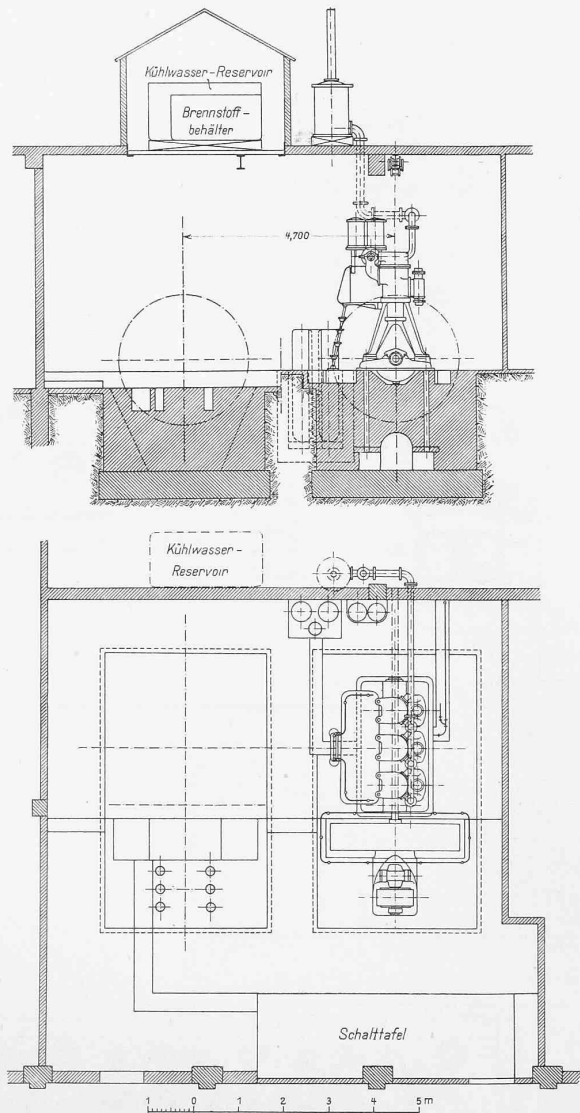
Grundriss und Aufriss der elektrischen Kraftanlage für die Automobilfabrik «Safir». — Masstab 1 : 150.
